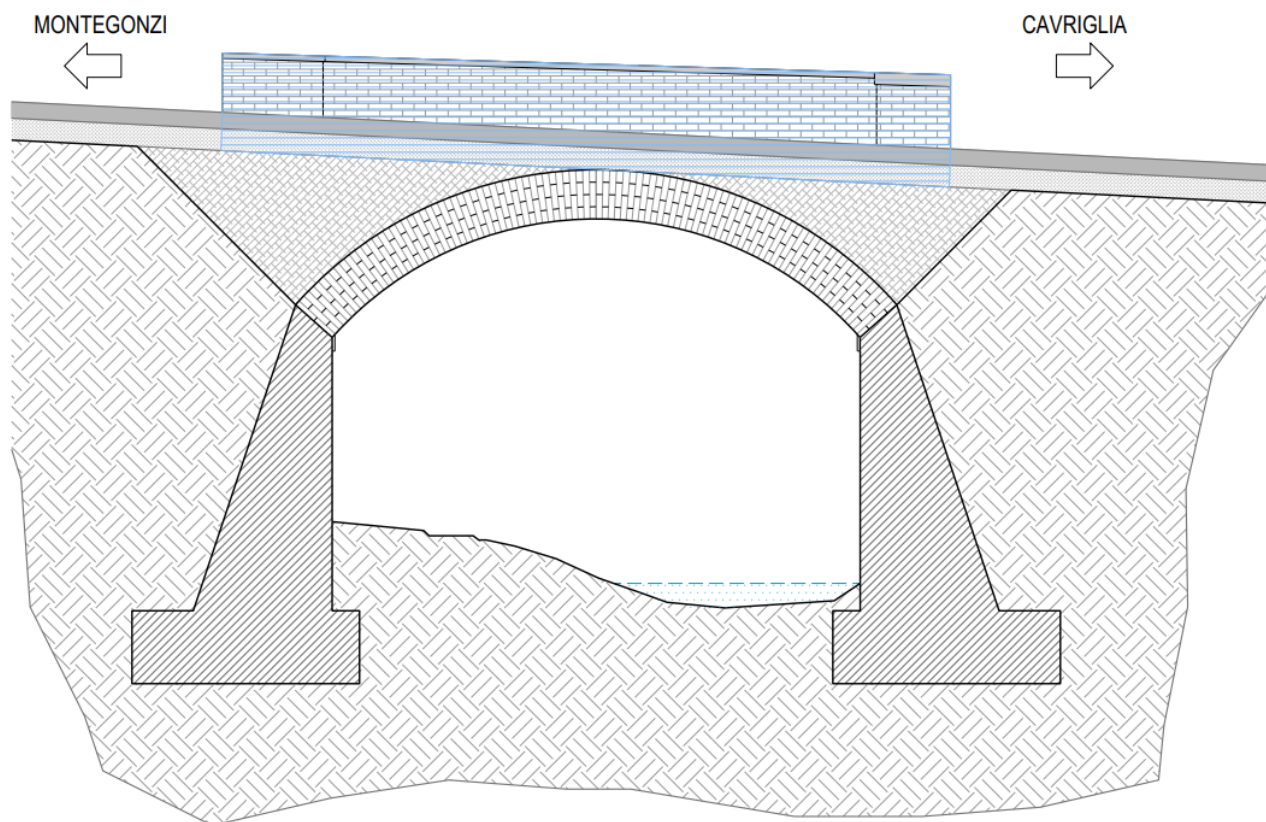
Stato di Progetto - Interventi di consolidamento - Sezione B-B
